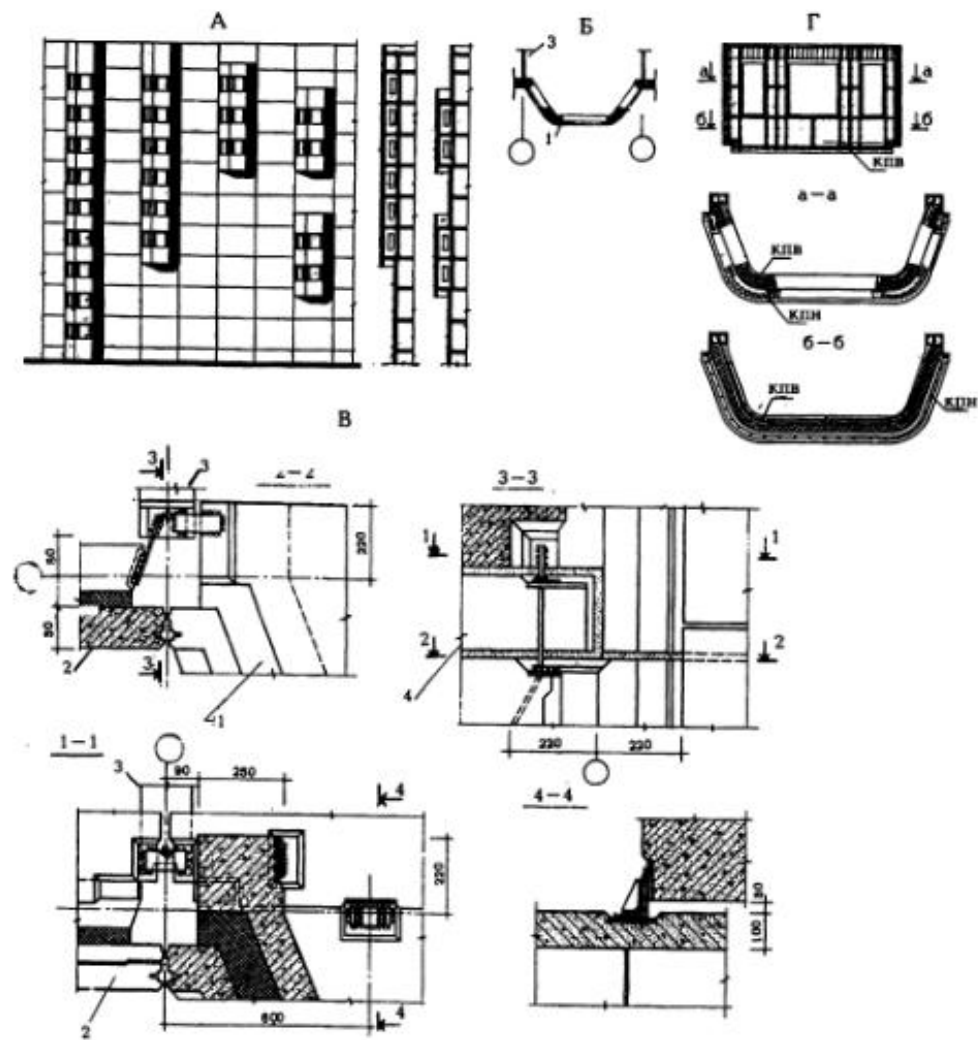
Объёмный эркер панельных зданий: А - схема компоновки на фасаде здания; Б - схема установки в плане; В - крепление объёмного элемента эркера; Г - схема армирования объёмного эркера; 1 - элемент объёмного элемента эркера; 2 - наружная стенная панель; 3 - внутренняя стенная панель; 4 - панель перекрытия; КРН, КРВ - каркас пространственного наружного (КРН) и внутреннего (КРВ) слоёв.
